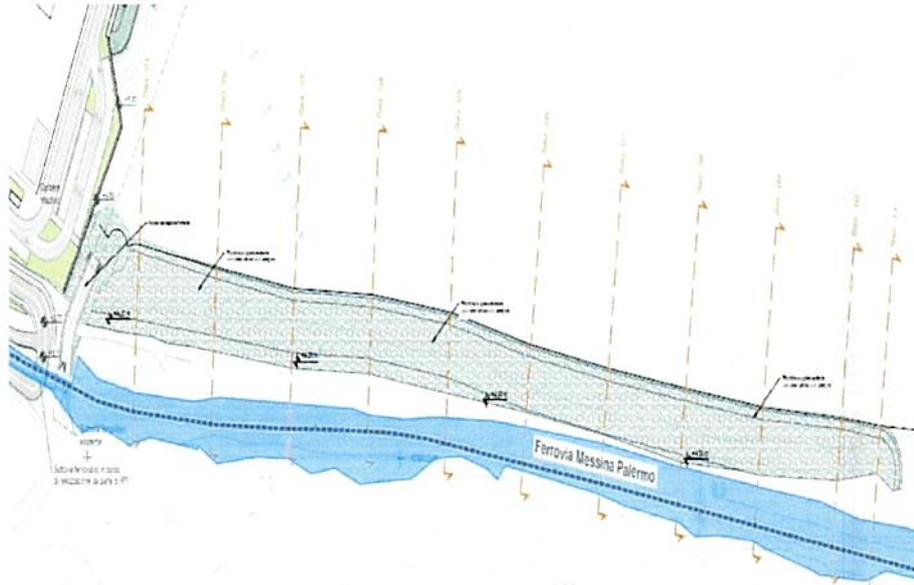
planimetria sovrapposizione viabilità portuale e progetto RFI (tav. VI\_16.1)
